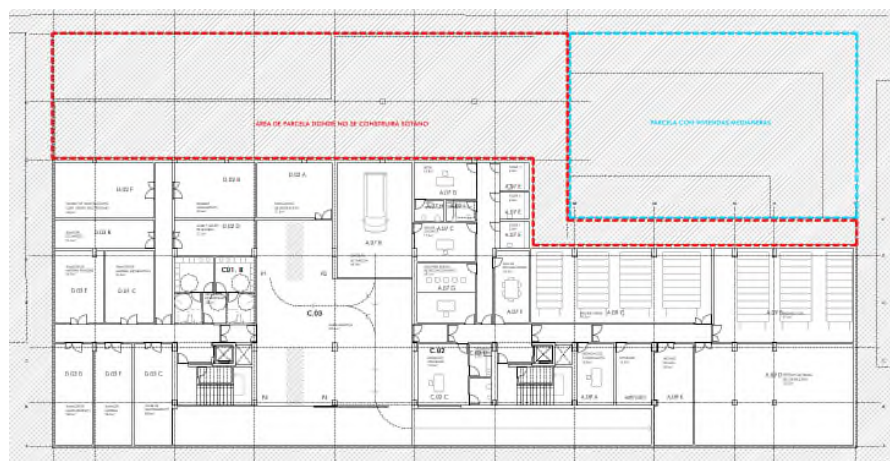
Detalle en planta de la zona del edificio libre de sótano (línea roja).
